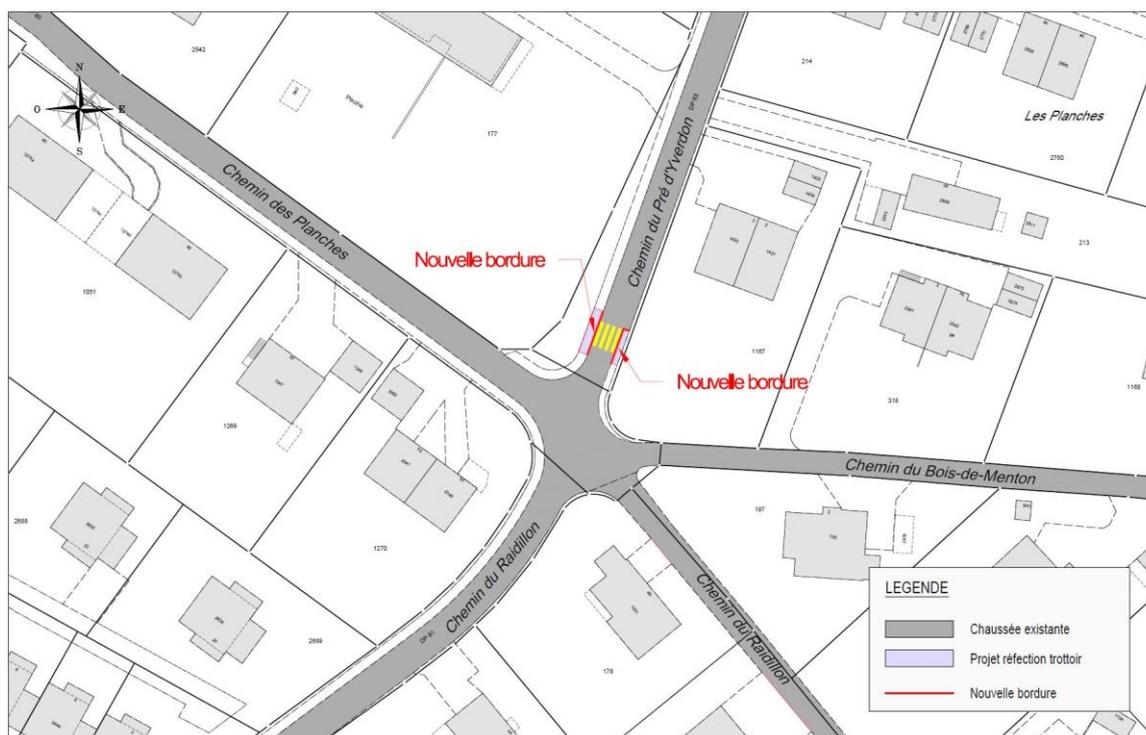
Plan des travaux sur le Ch. du Pré d'Yverdon
